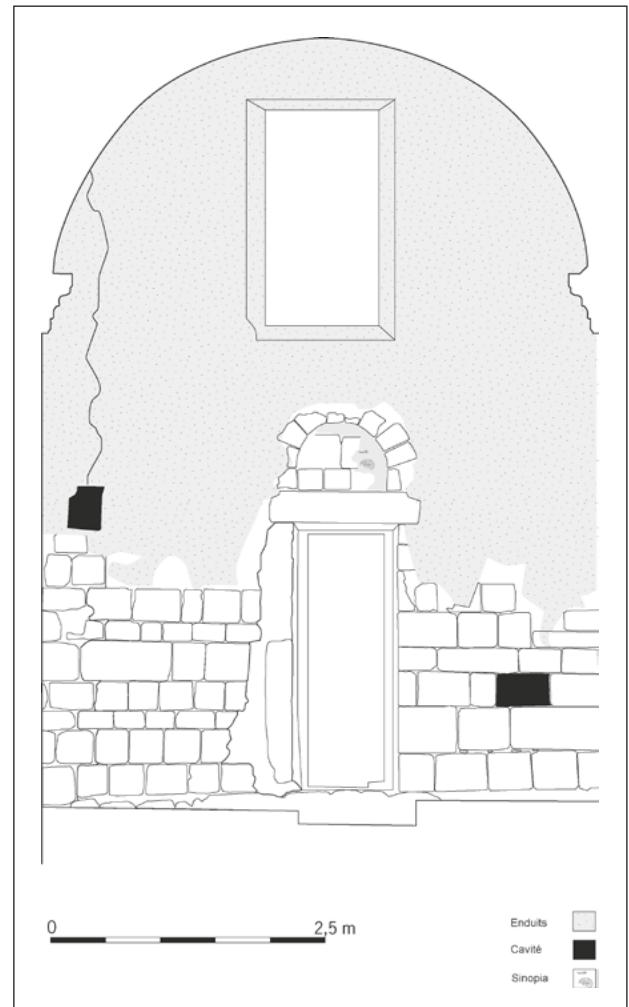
Relevé au pierre à pierre de la façade intérieure nord.
